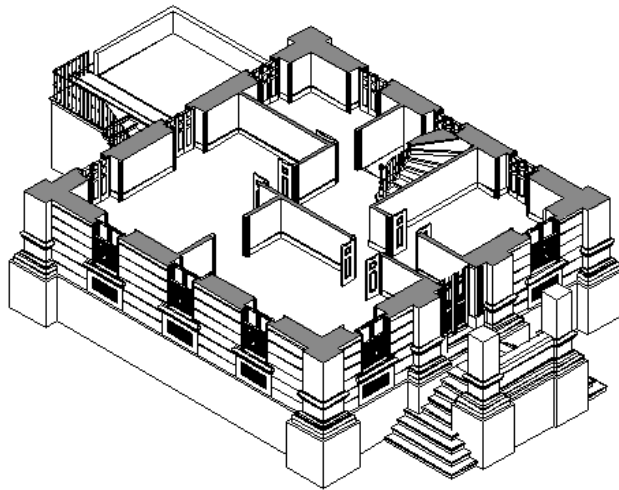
Axonometria do Piso 1 (Geostar, Levantamentos arquitectónicos)
